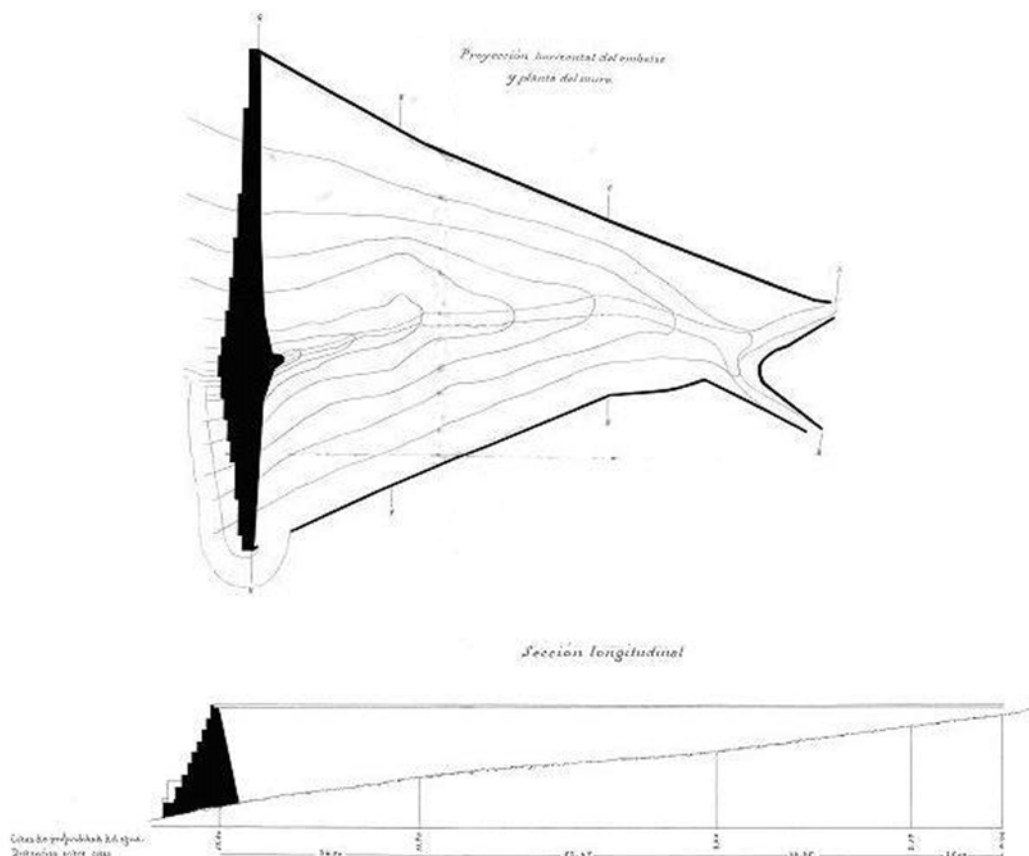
Proyección horizontal del embalse, planta del muro y sección longitudinal
